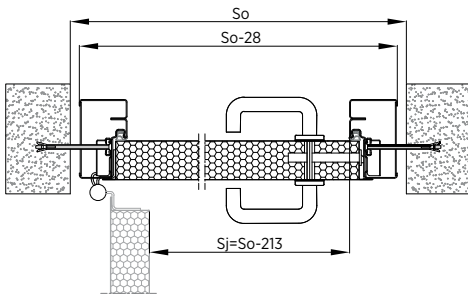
Pose au mur – porte à un vantail – bâti intérieur à rupture de pont thermique – coupe horizontale
